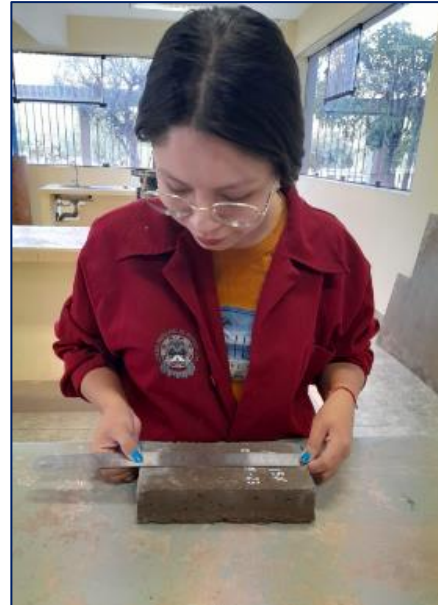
Tesistas realizando el ensayo de tolerancia dimensional
